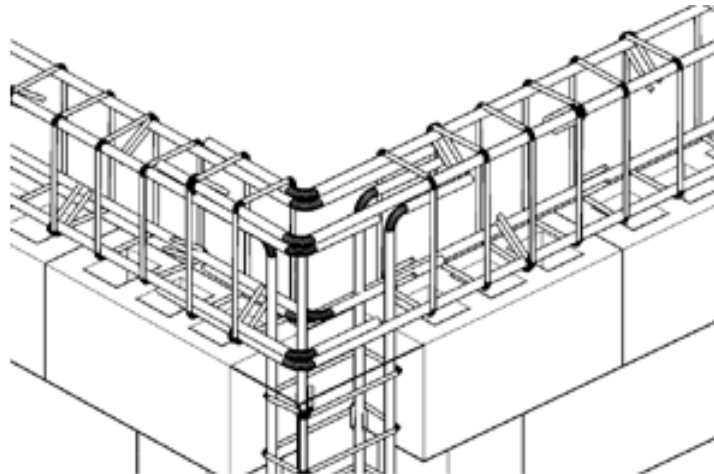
Detalle de las barras de refuerzo en un pilar de esquina, encuentro en L (Totten, 2010)
